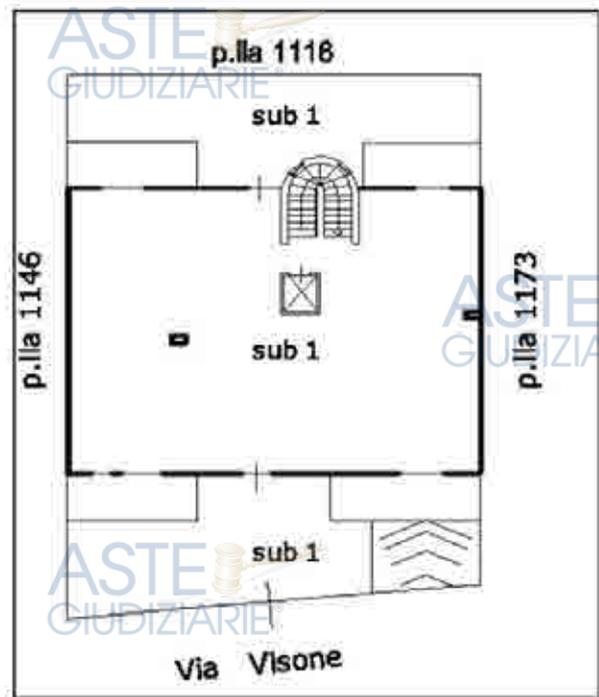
Elaborato planimetrico PT del 30/07/2015
